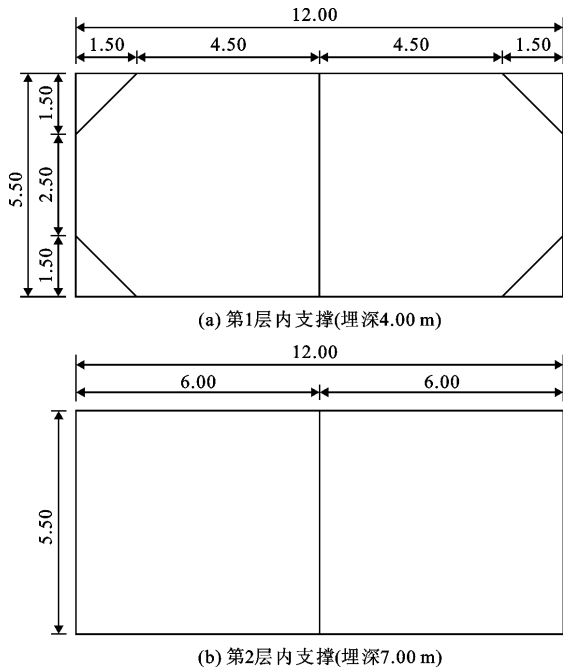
实例工程基坑支护结构内支撑平面图(单位:m)
